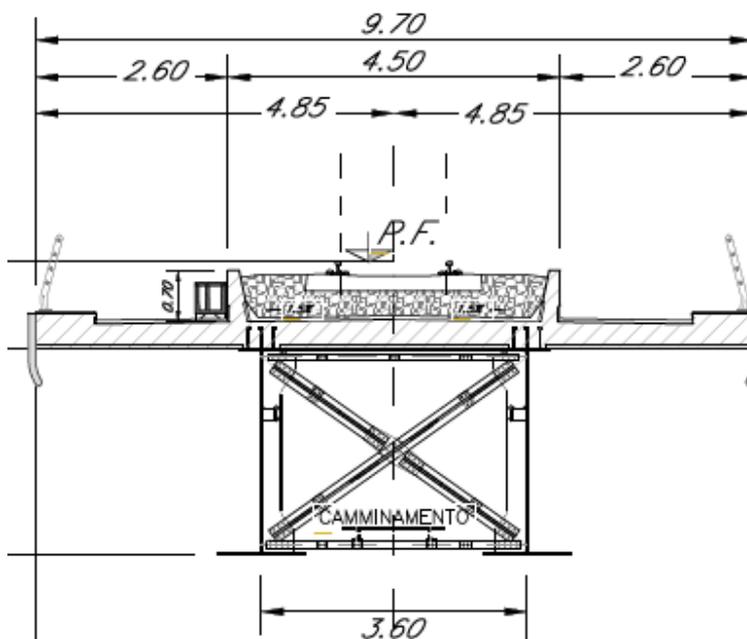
Sezione tipo campate a sezione mista acciaio - cls (da 40 - 50 - 60 m) a singolo binario
